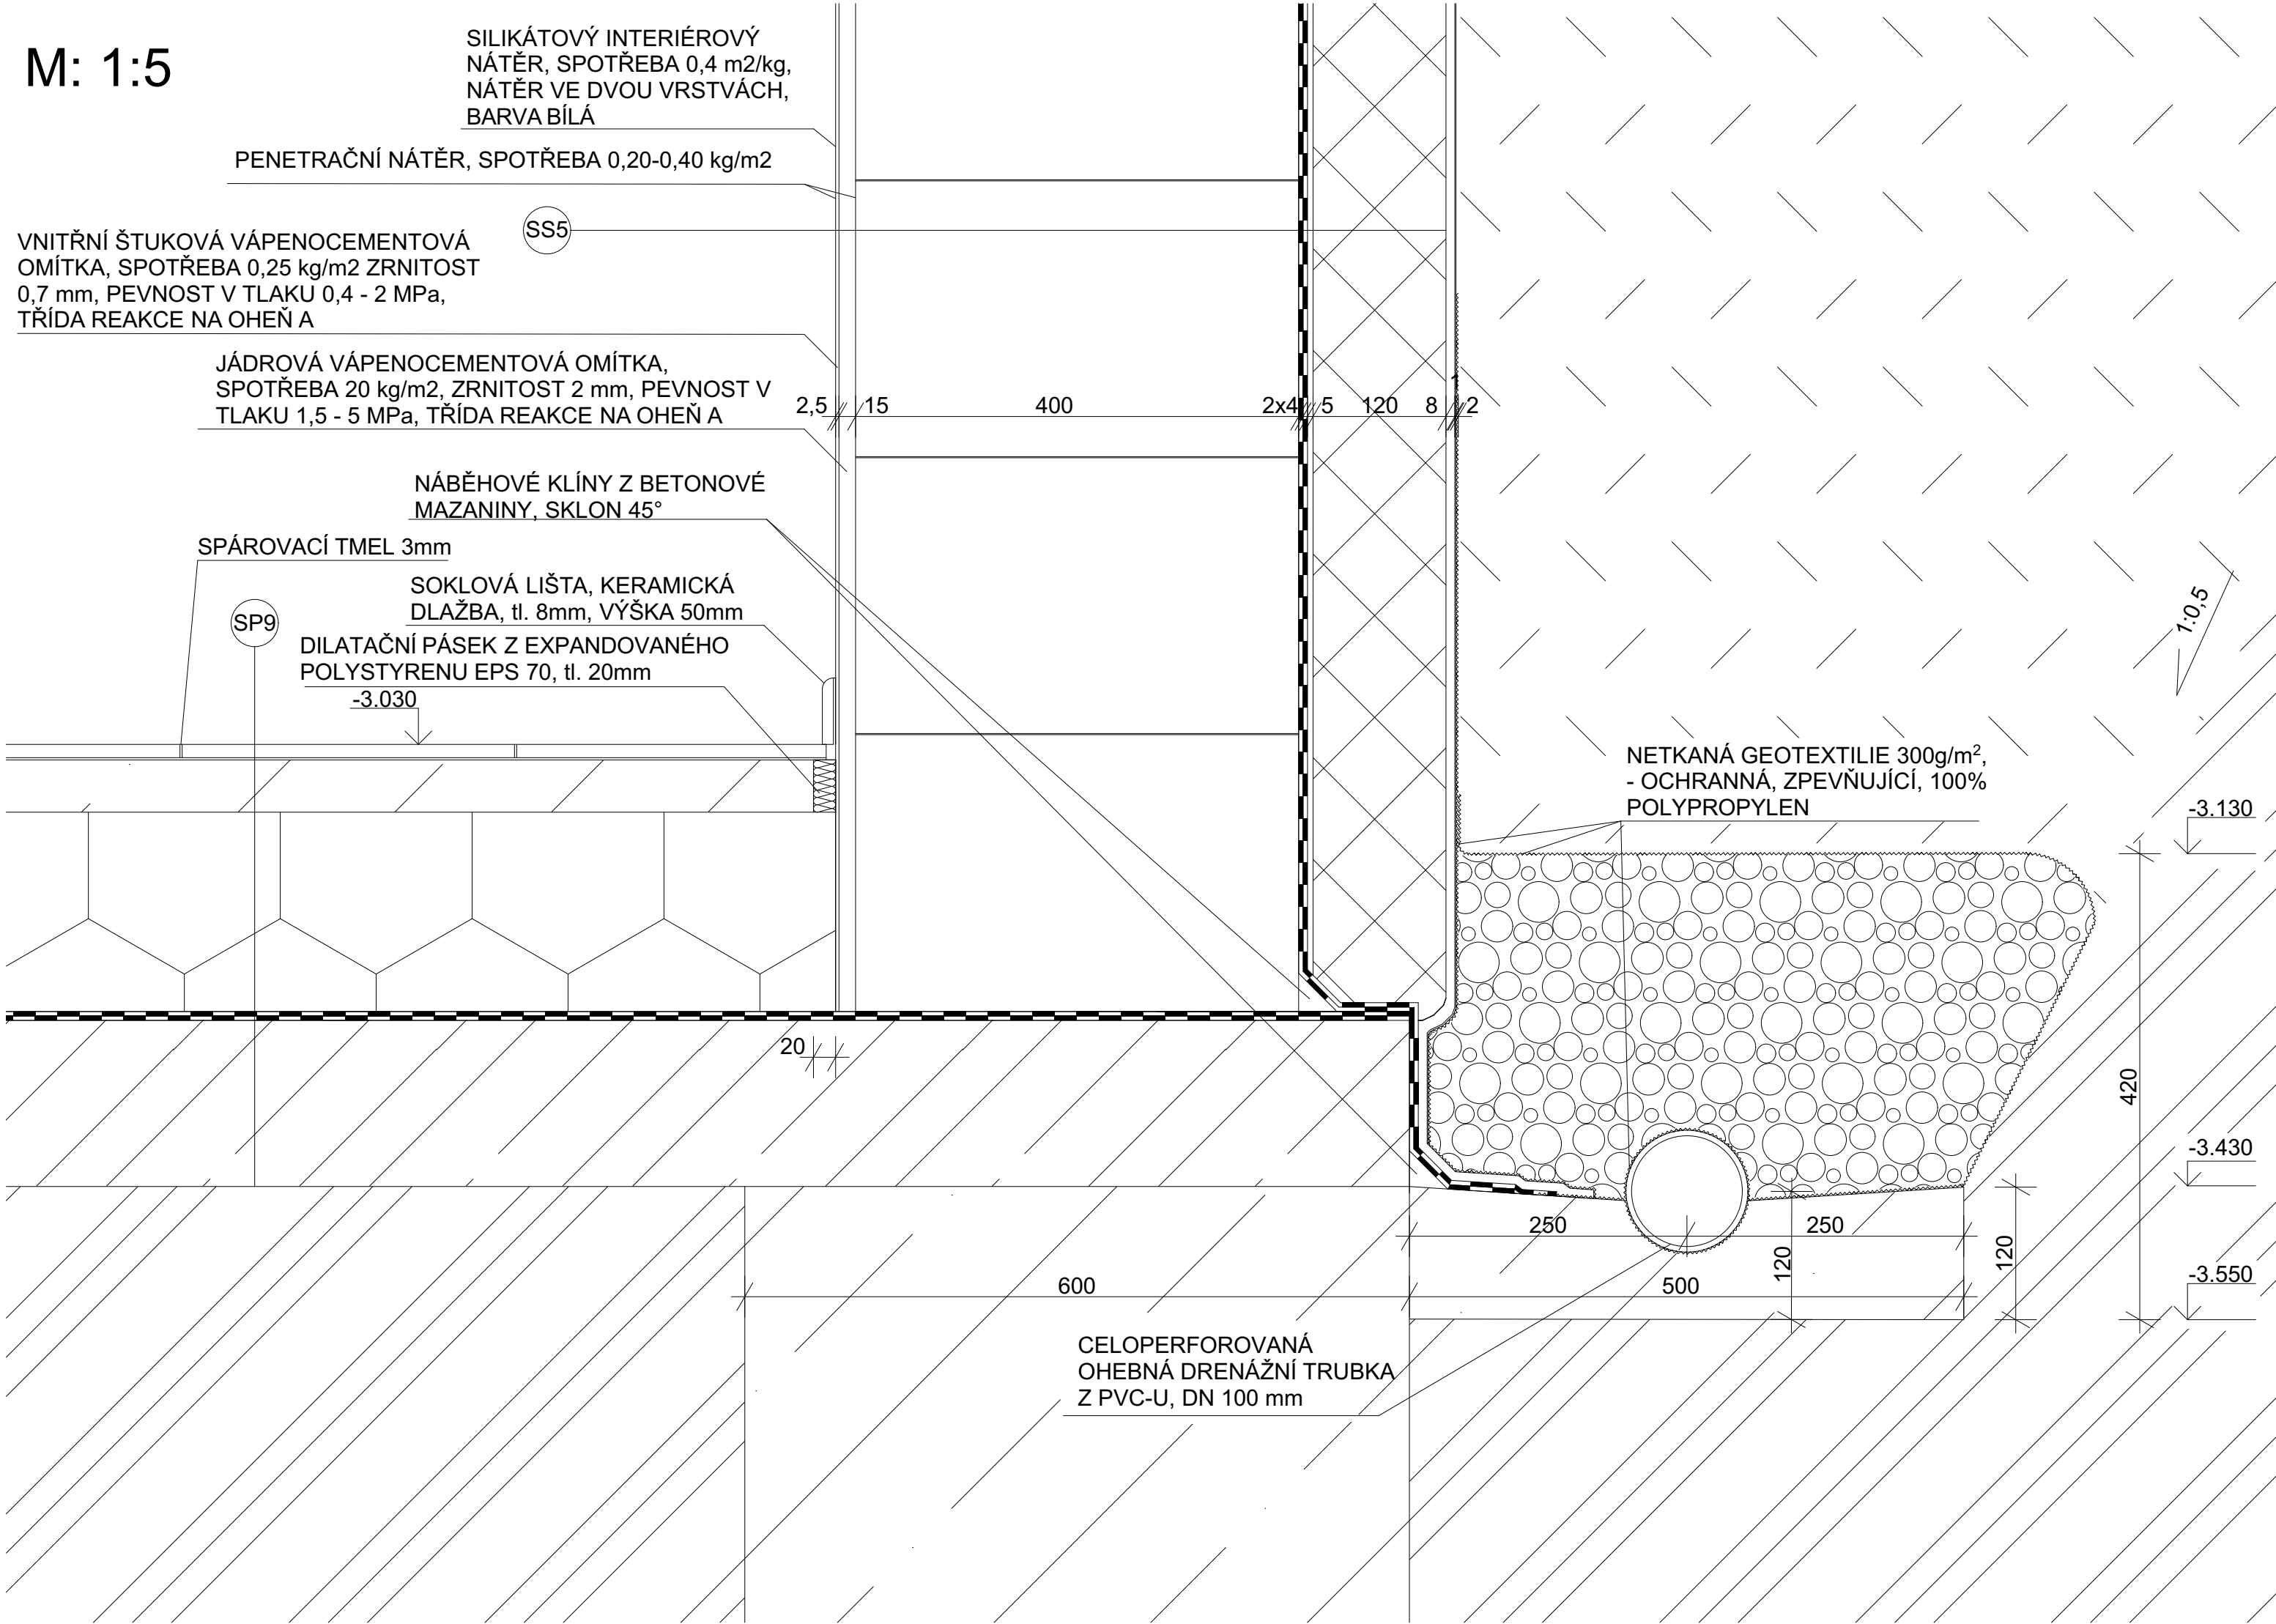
ULOŽENÍ DRENÁŽE
